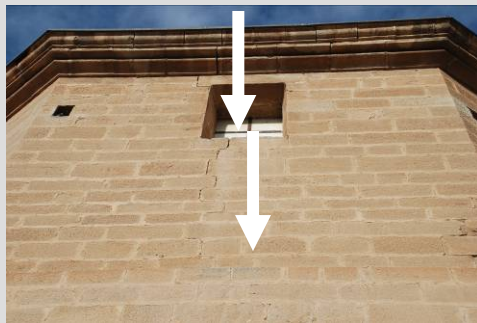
Fisura en centro muro testero (Franciscanos, Alcañiz)
